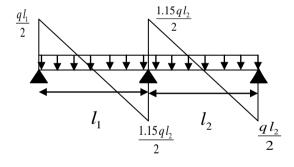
L'Effort tranchant d'une poutre à plus de 2 travées Figure 21 L'Effort tranchant sur une poutre à 2 travées
